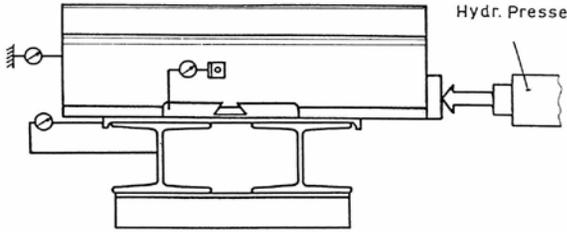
Abbau der Flächenpressung am Schwellenaufleger
